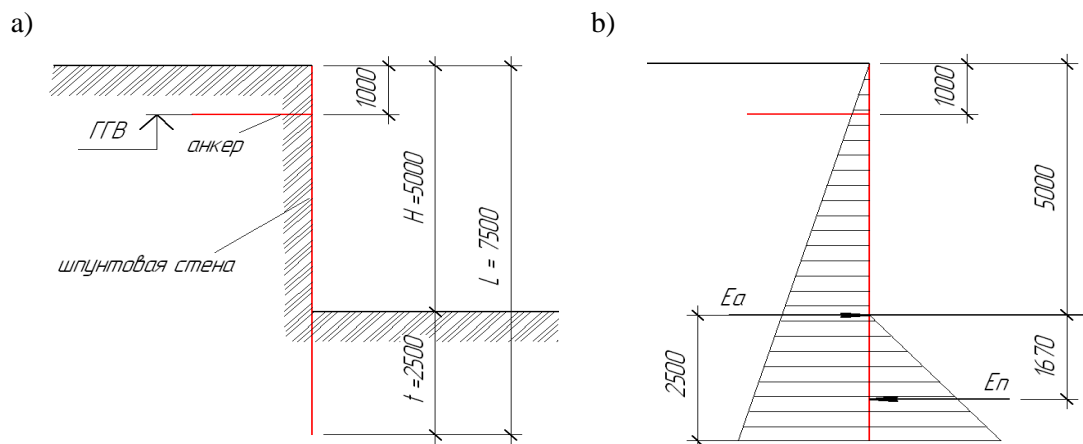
Крепление стенок котлована шпунтовым свайным рядом с анкерровкой:
